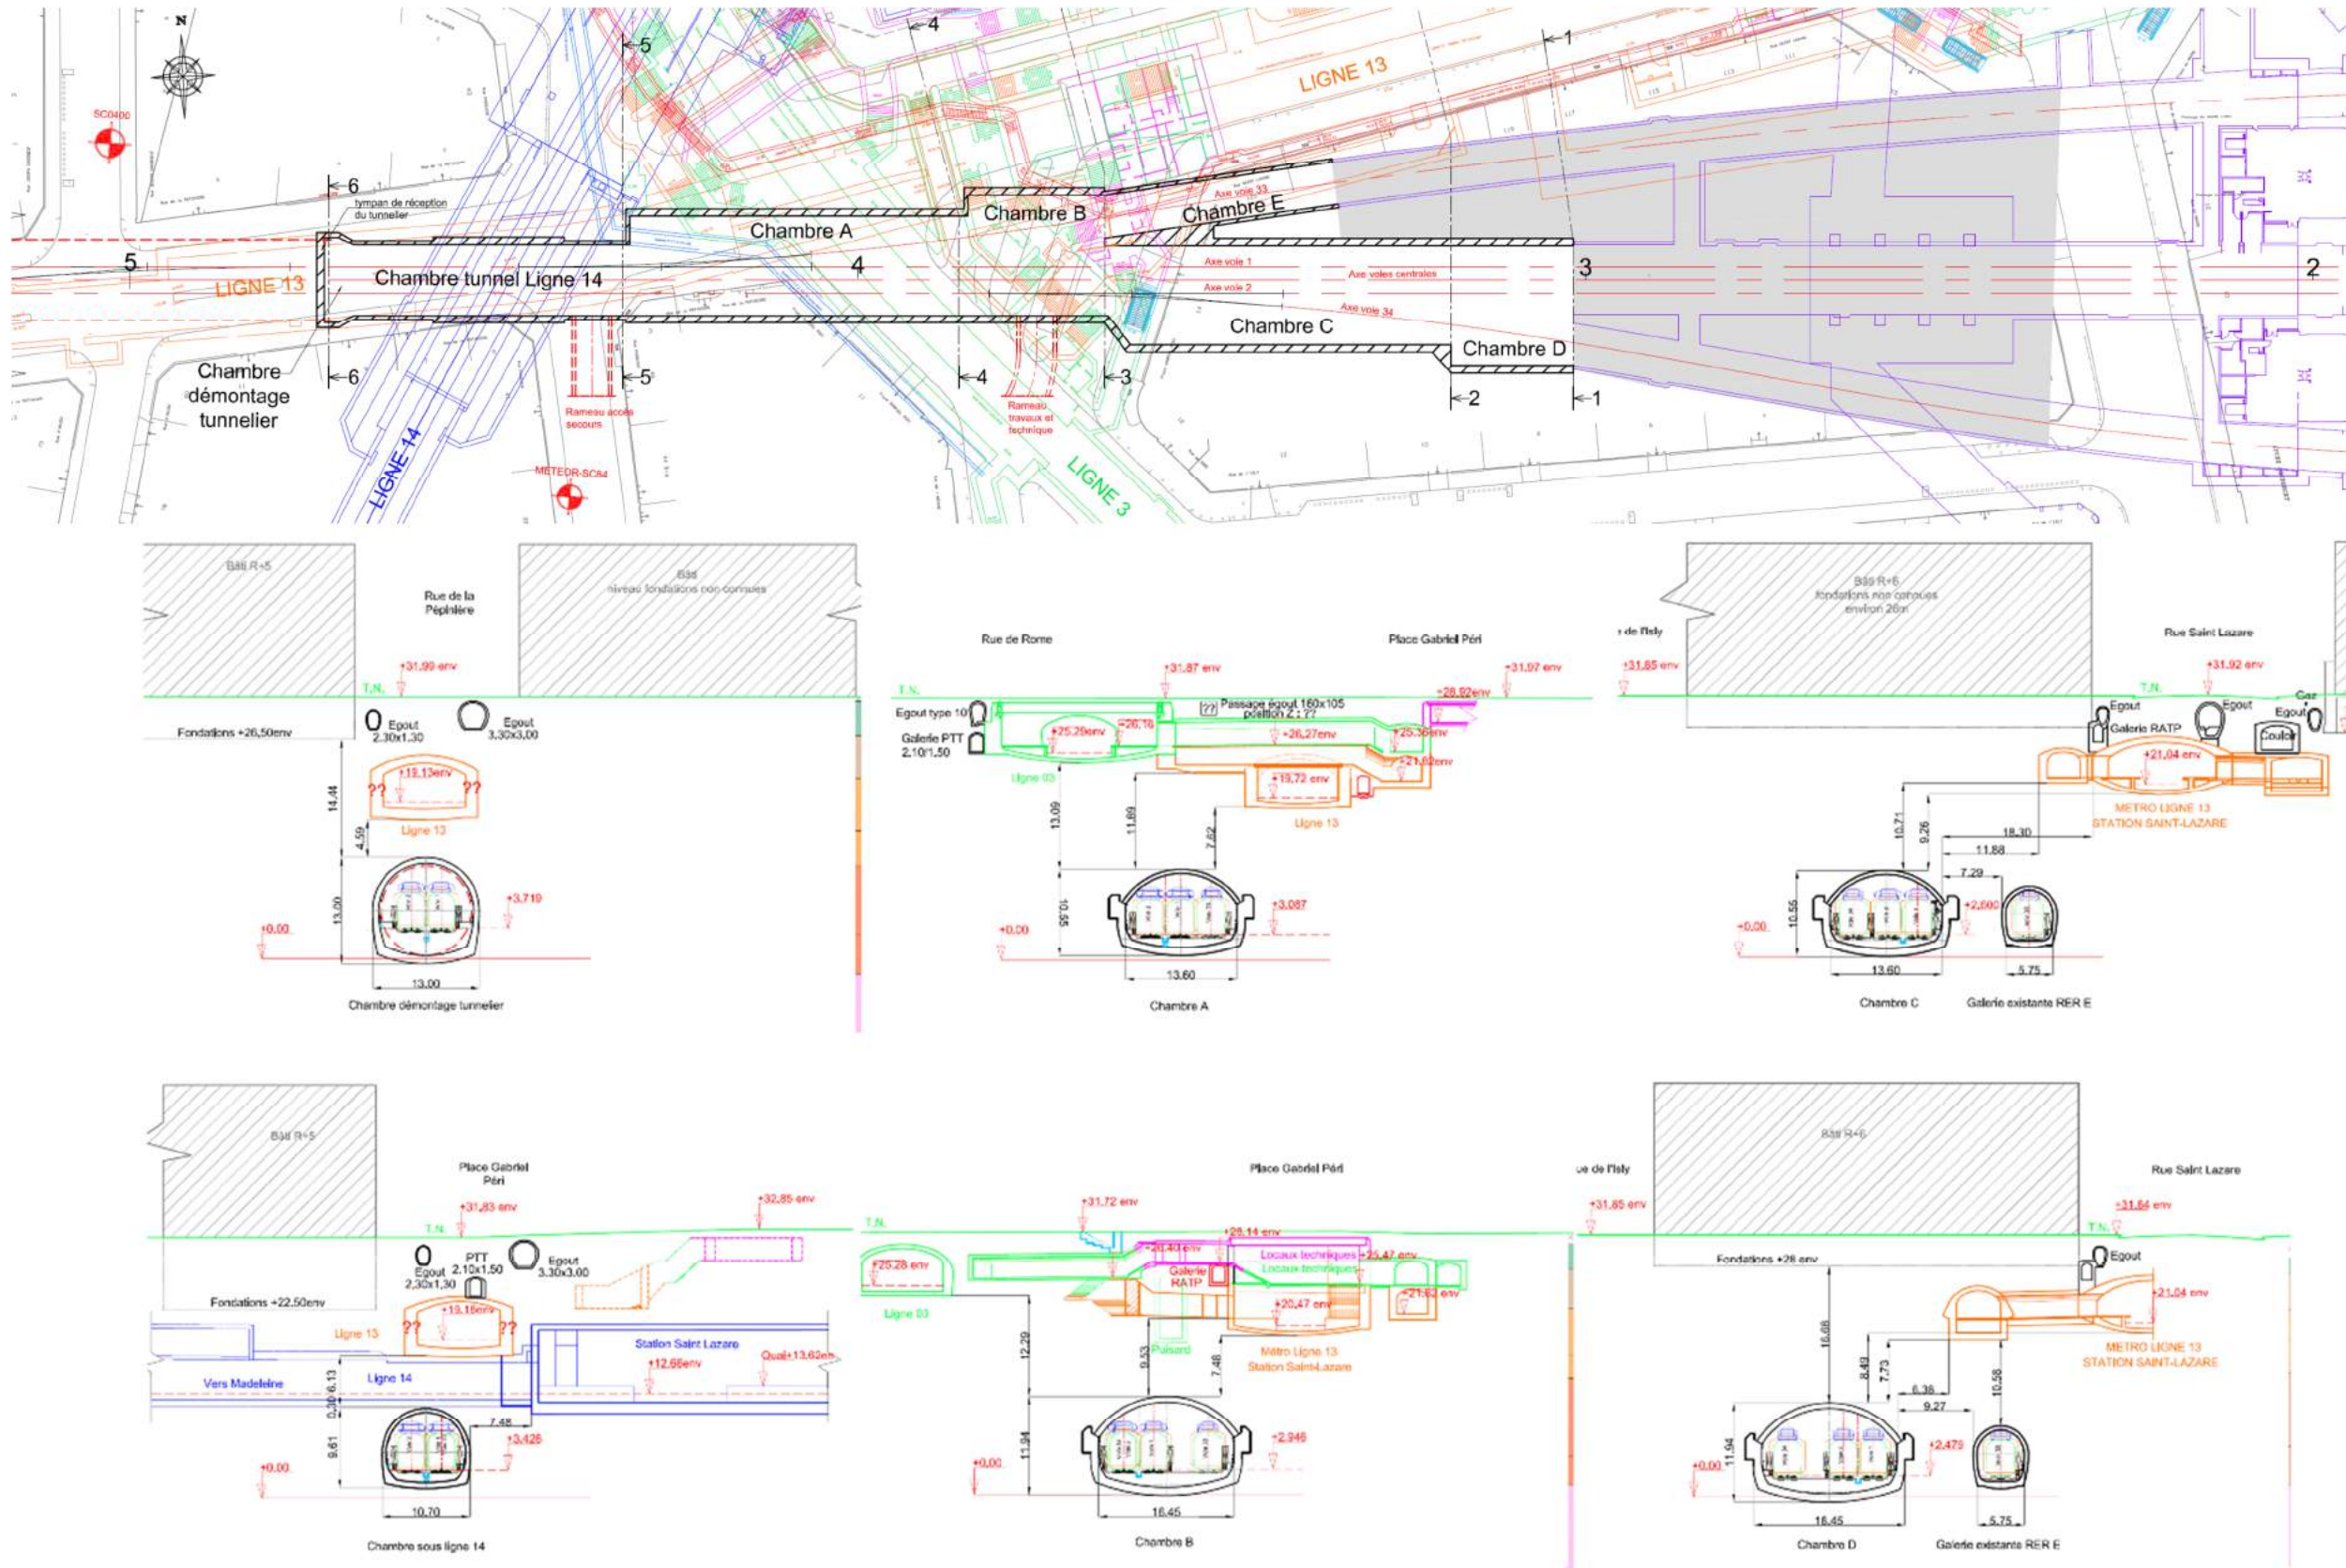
Plan et coupes des chambres de l'entonnoir Haussmann-Saint-Lazare
